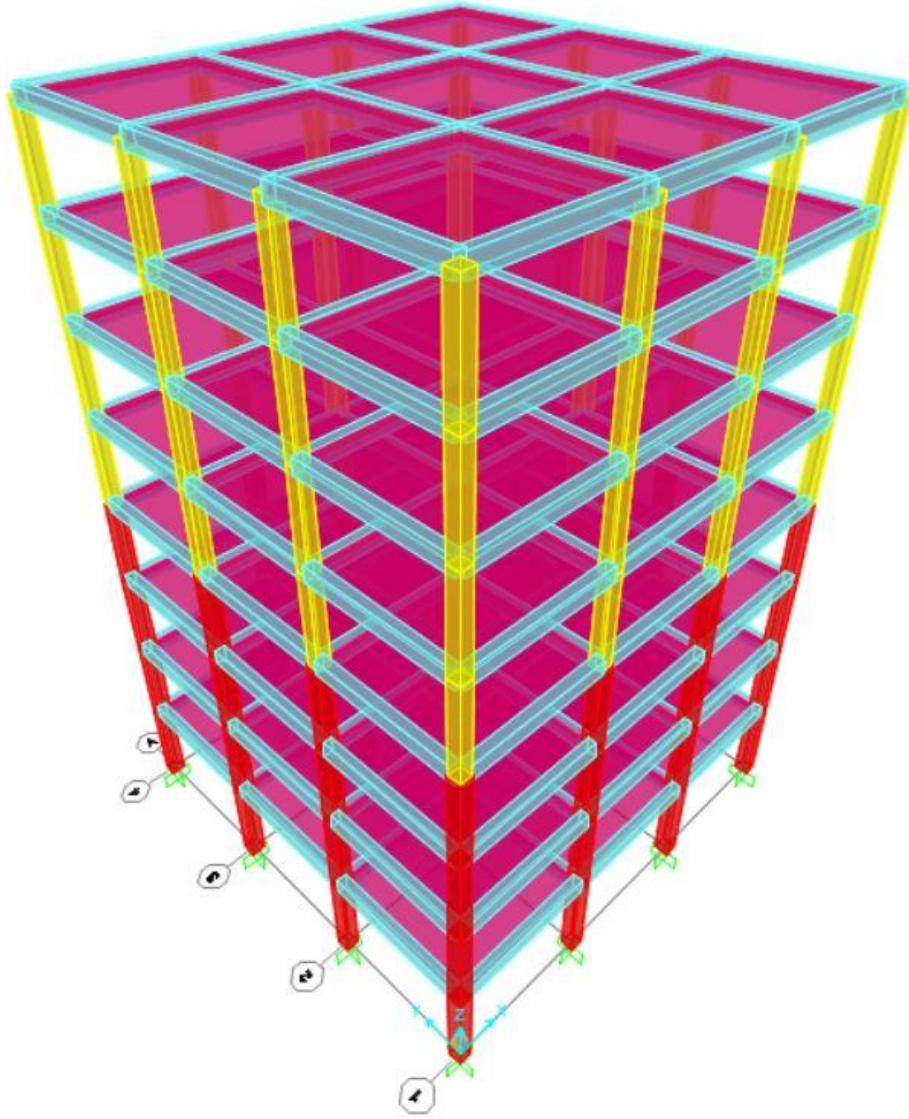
8 Katlı yapının şematik plan görünüşü.
